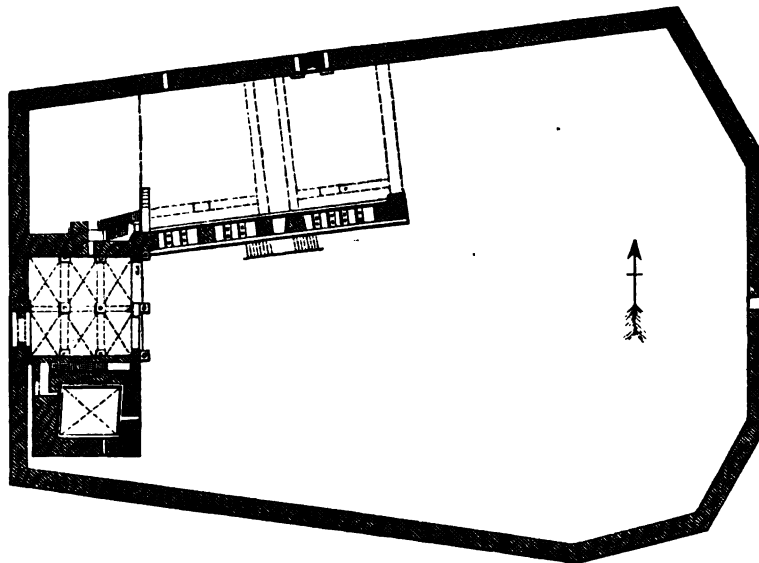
Grundriss des Schlosses zu Gelnhausen.
